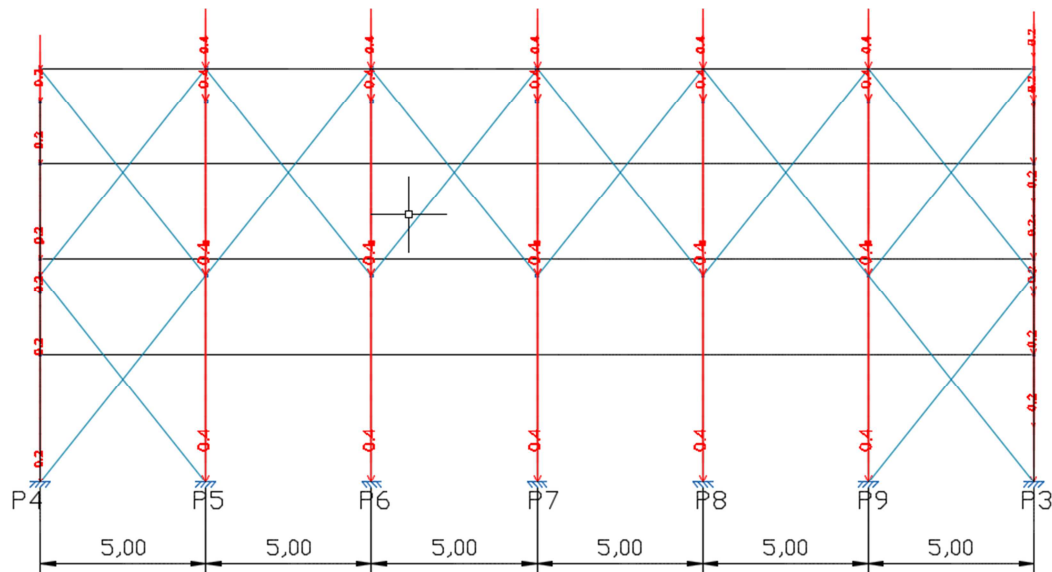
Carga repartida de la chapa de fachada sobre pilares alzado lateral
